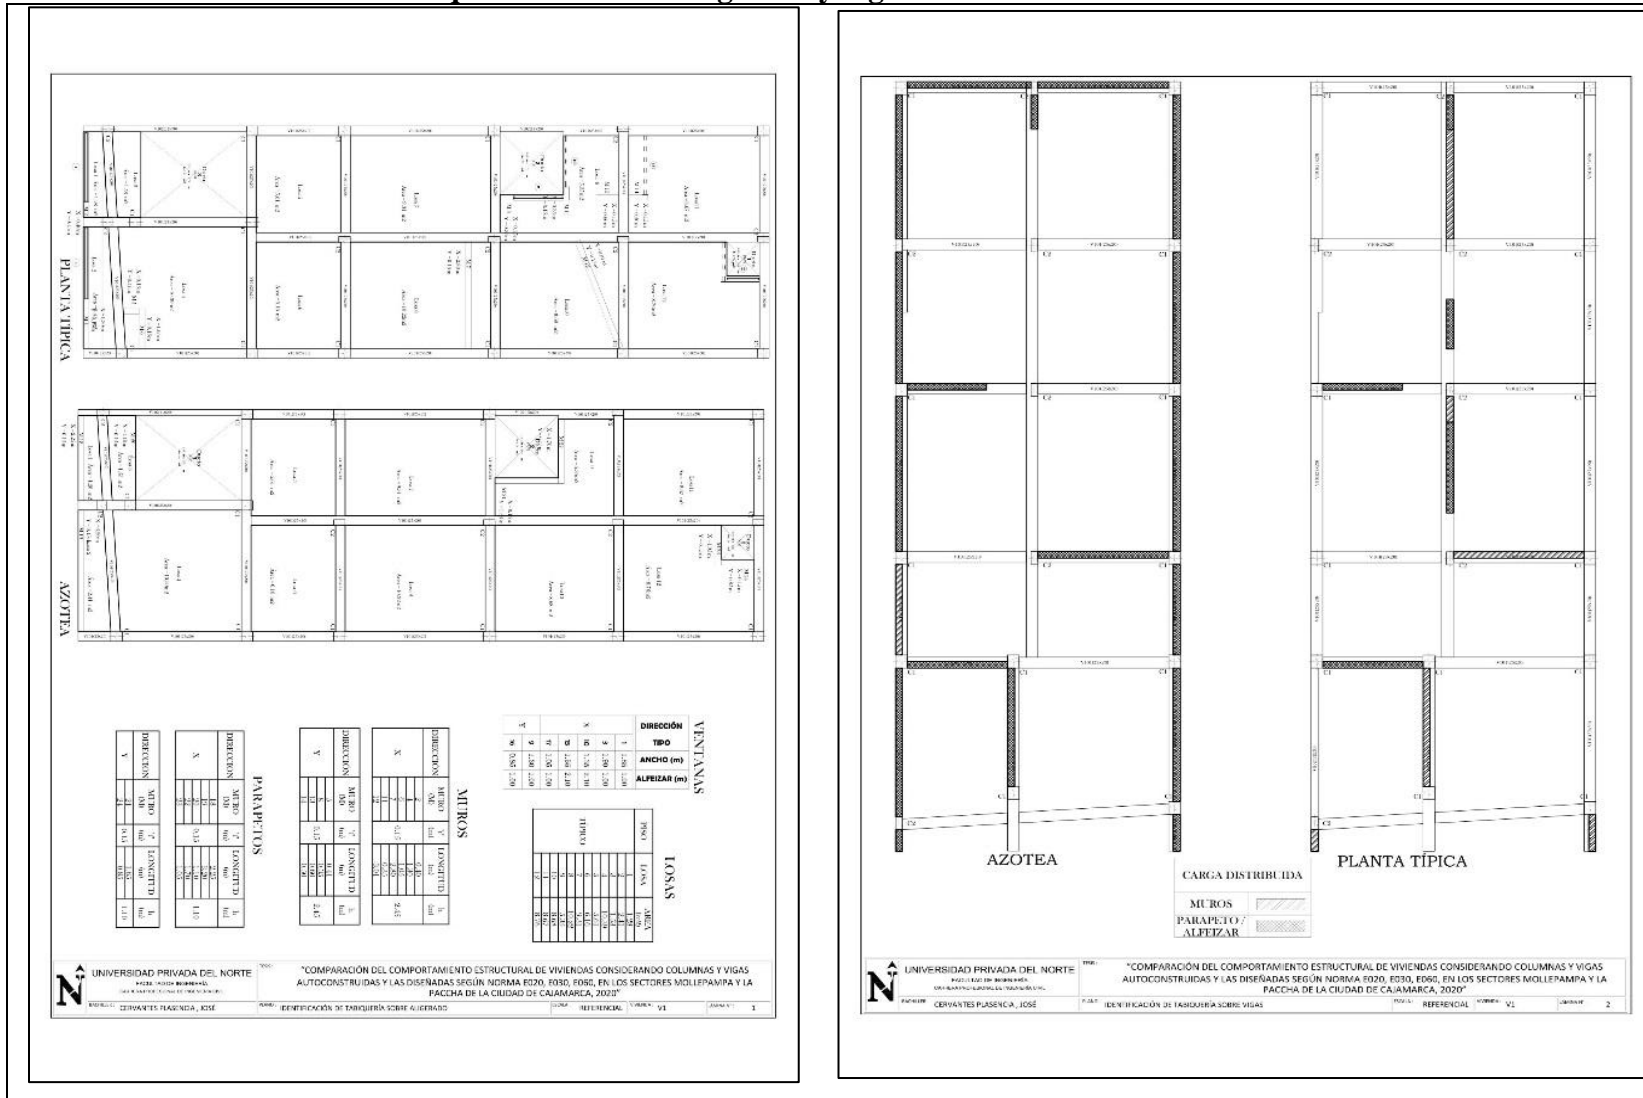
Tabiquería sobre losa aligerada y vigas vivienda 2
